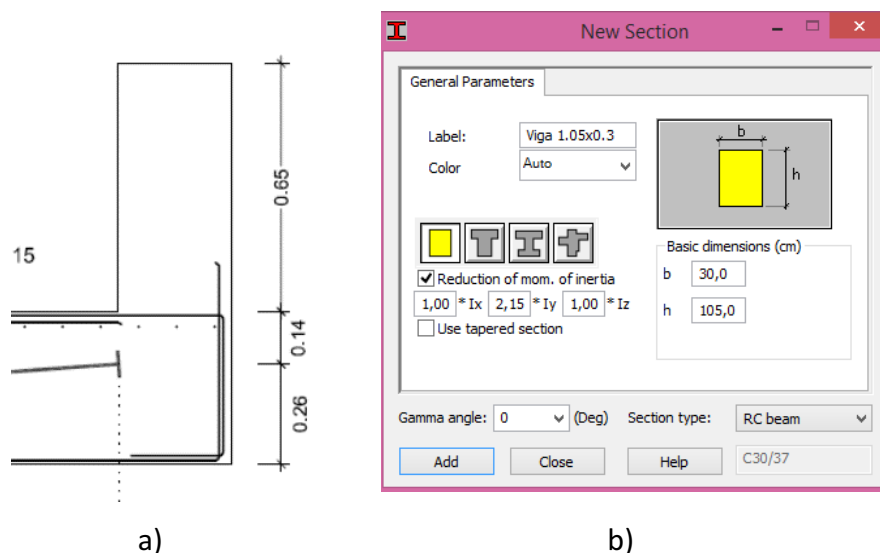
a) Pormenor da Viga e b) Incremento da Rigidez
